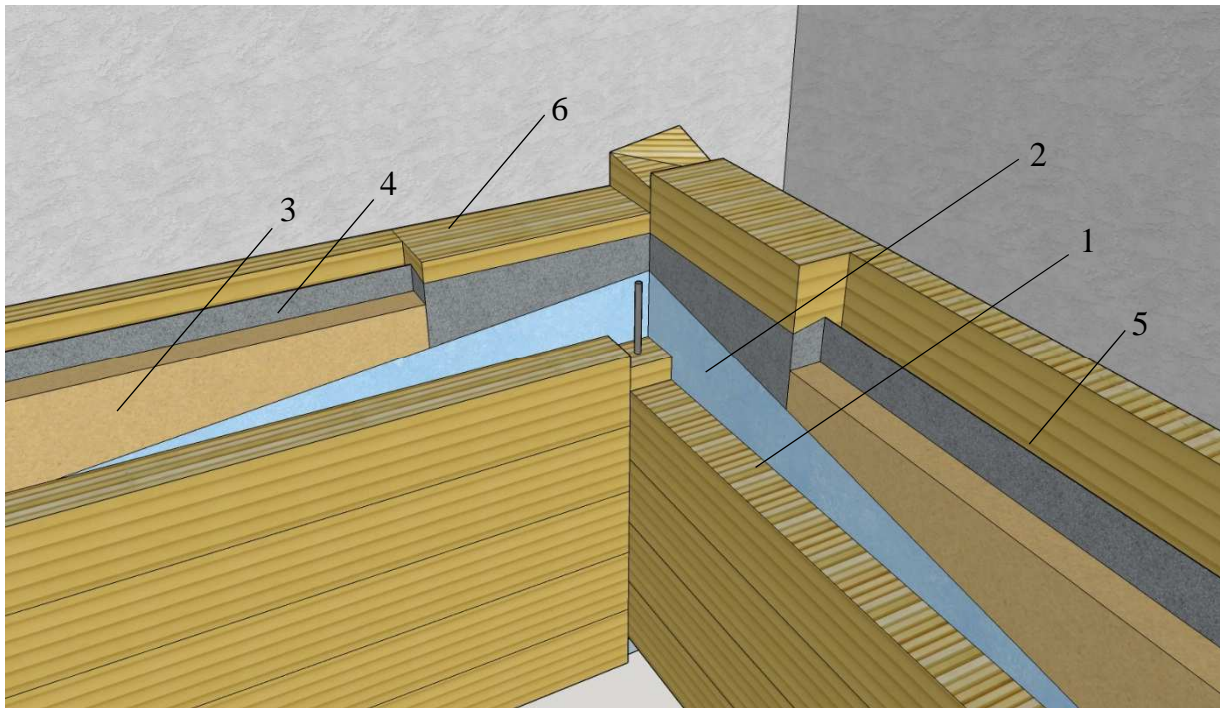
Model navržené konstrukce 2.1 – (1) vnitřní konstrukce, (2) parozábrana
